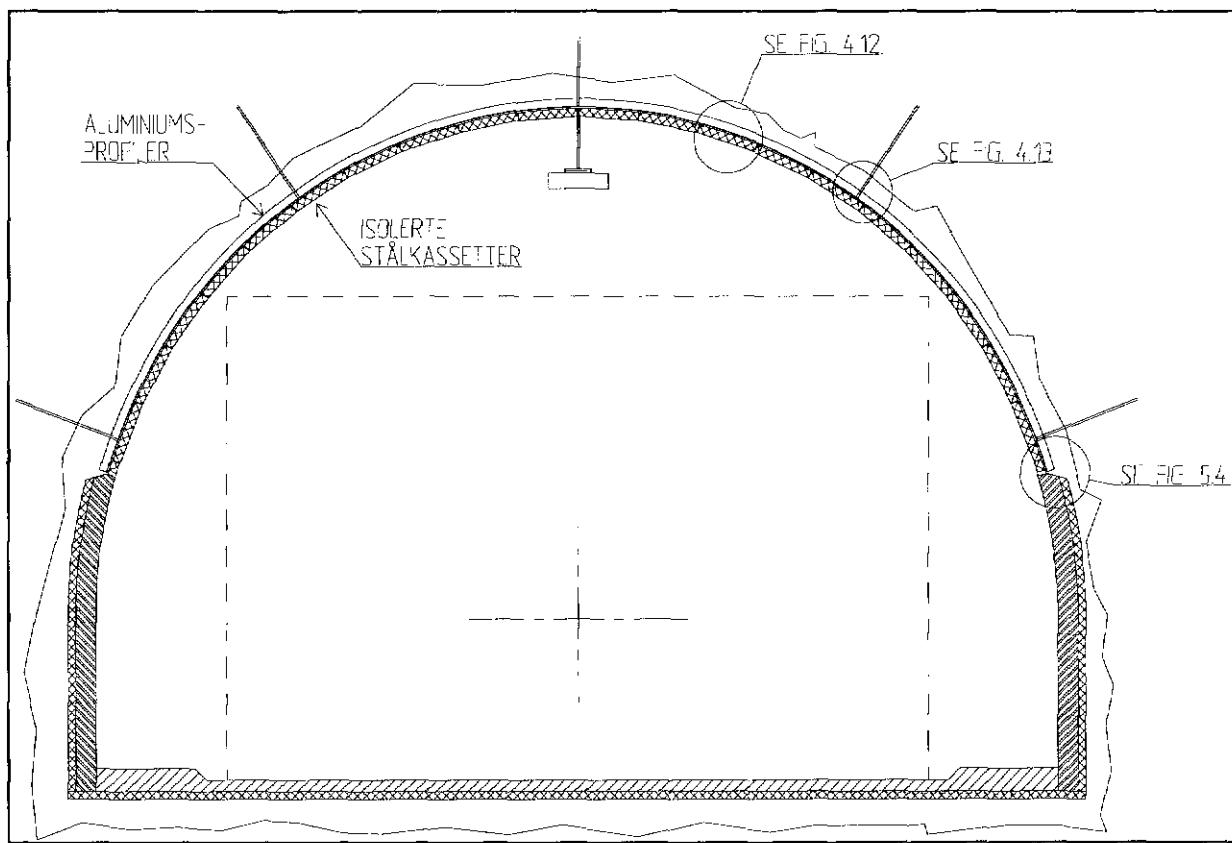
Overgang mellom ekeberghvelv og betonelementer.
